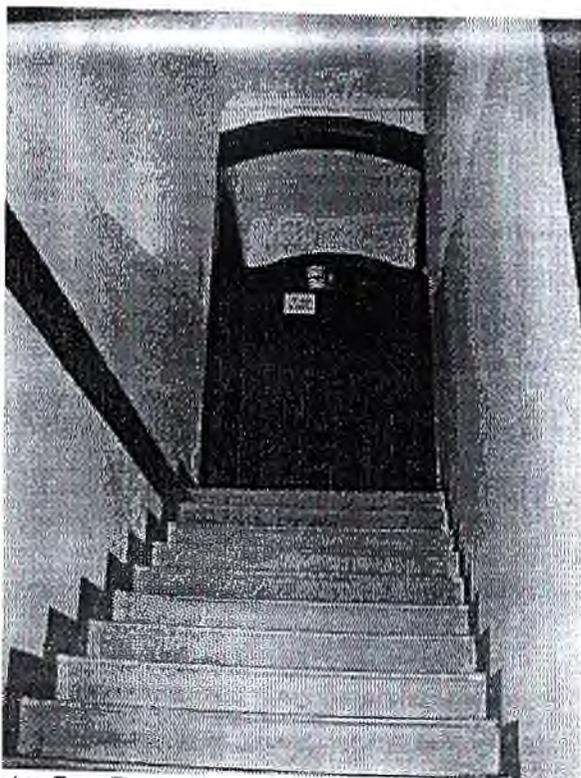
Escada de acesso do 1º ao 2º pavimento
